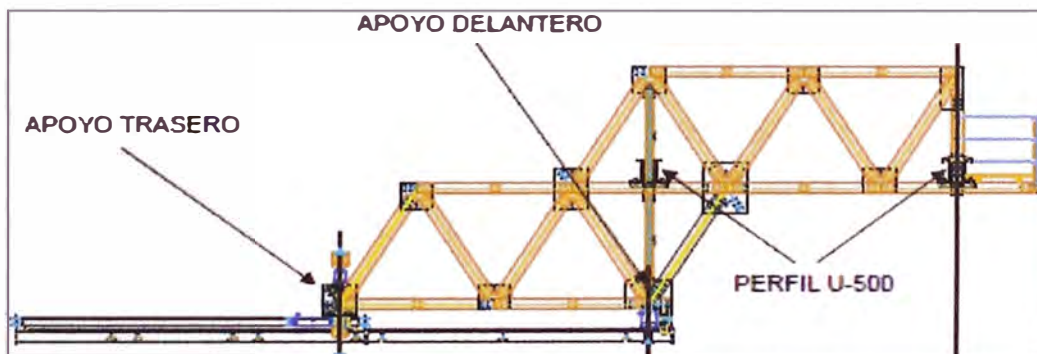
Vista Elevación apoyos delantero y trasero.
